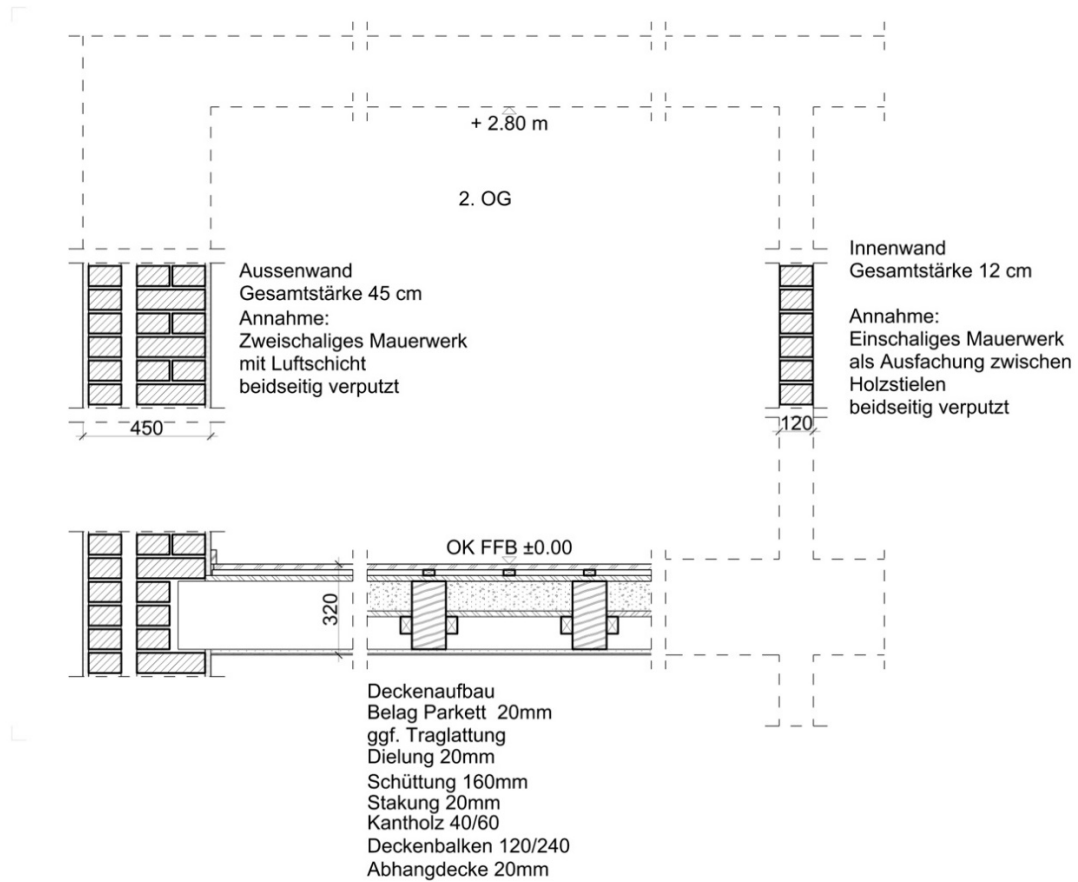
Detailzeichnung des Modellzimmers mit Holzbalkendecke.
